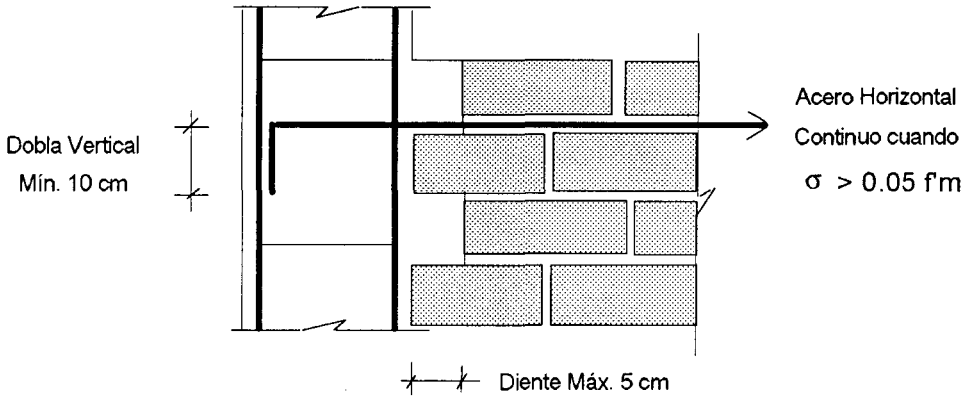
Detalle del anclaje del refuerzo horizontal continuo en un muro confinado (Ref. 2)
